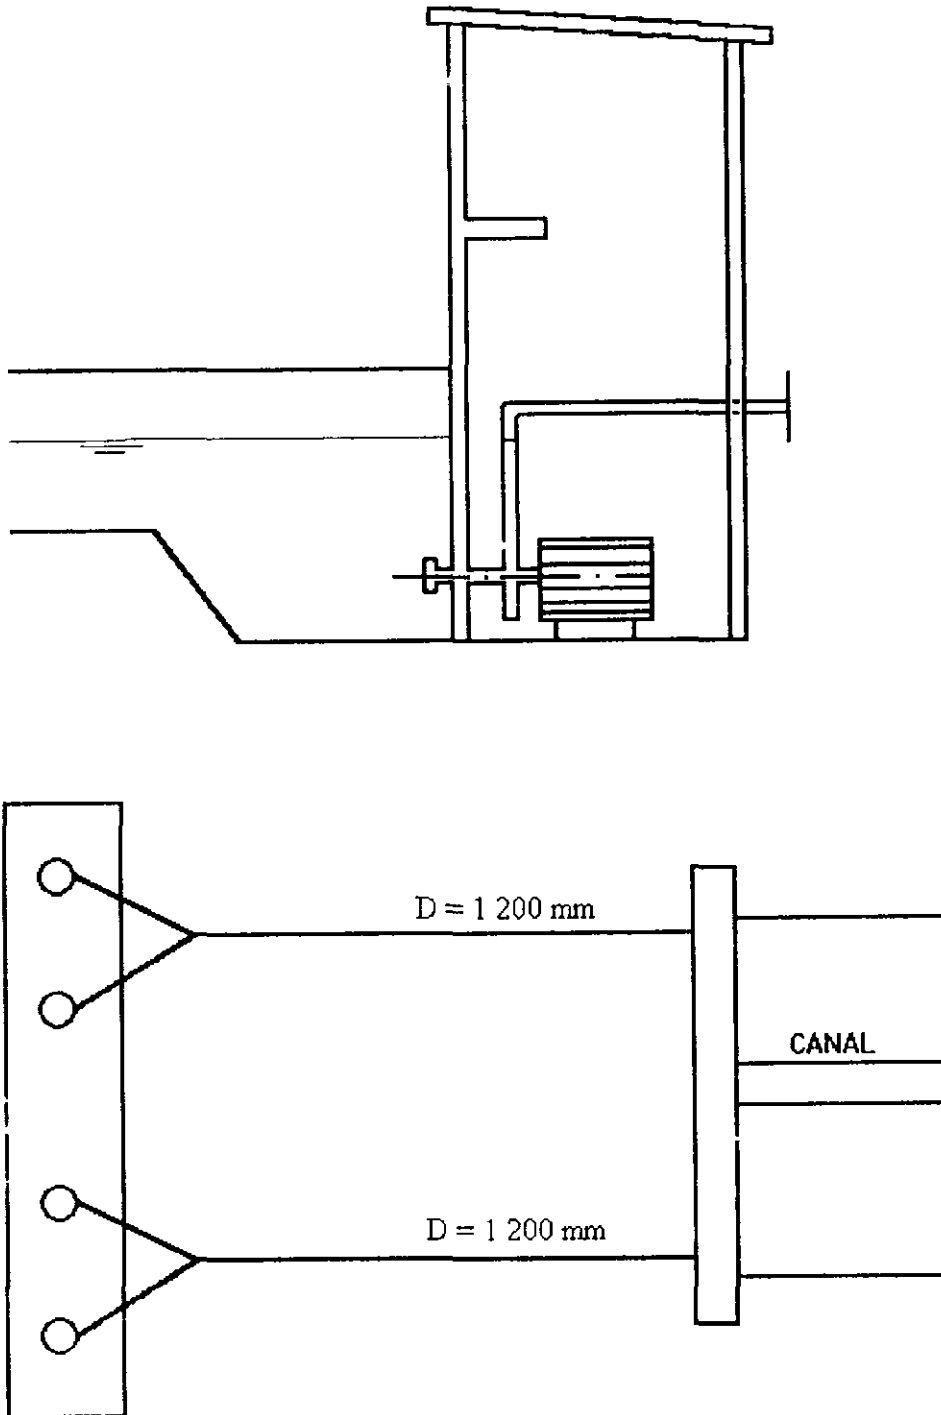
1 - Arranjo da Estação Elevatória Principal - Alternativa 1
